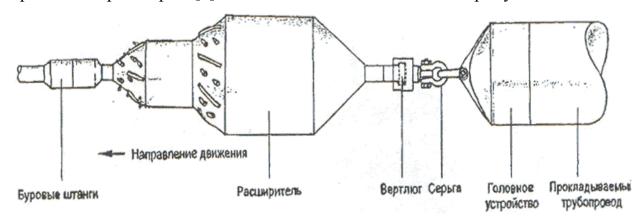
схема соединения расширителя с трубопроводом
